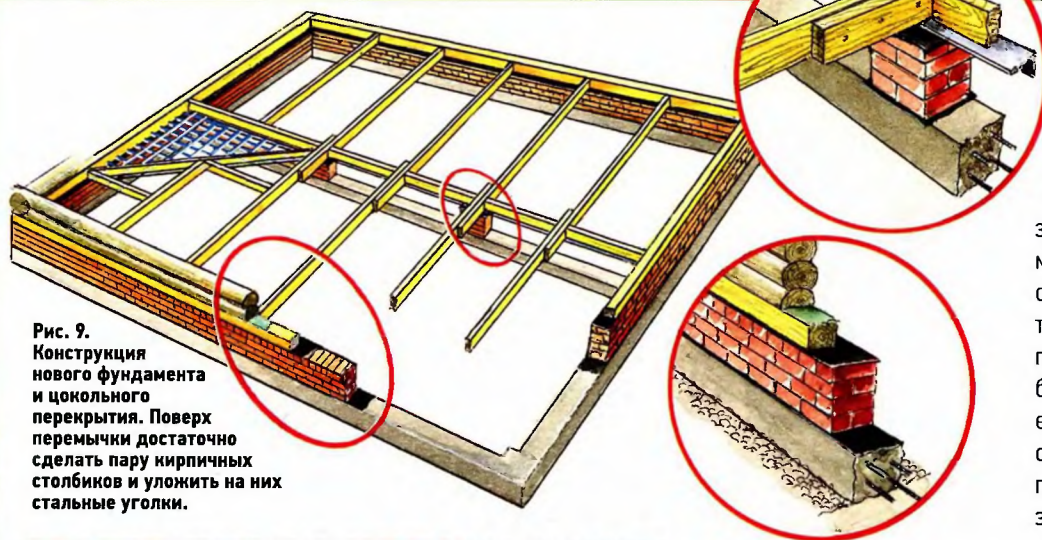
Конструкция нового фундамента и цокольного перекрытия. Поверх перемычки достаточно сделать пару кирпичных столбиков и уложить на них стальные уголки.
